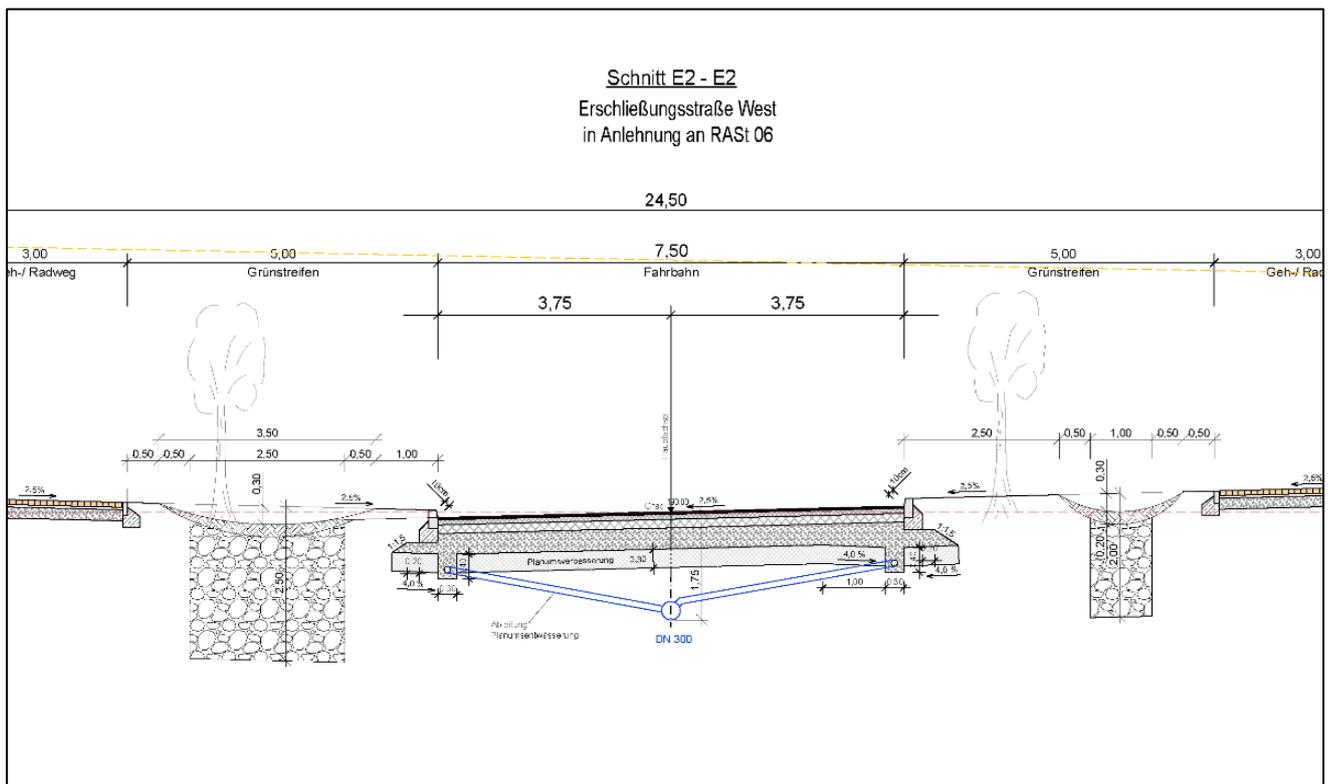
Schnitt Erschließungsstraße mit Rigolen, Ausschnitt aus Plan RK-02 [4]
